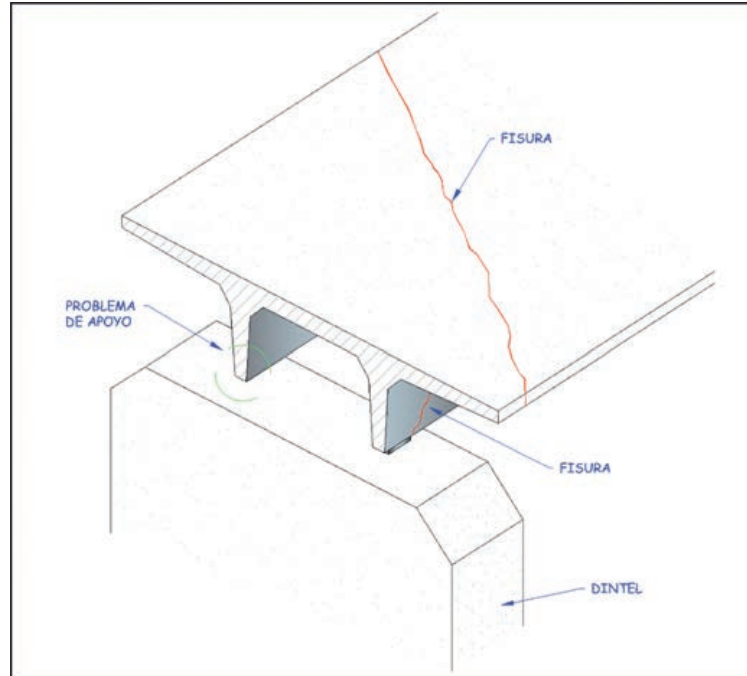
FISURACIÓN DE VIGA EN «PI» DEBIDO A UN DESCALCE EN UN APOYO.
